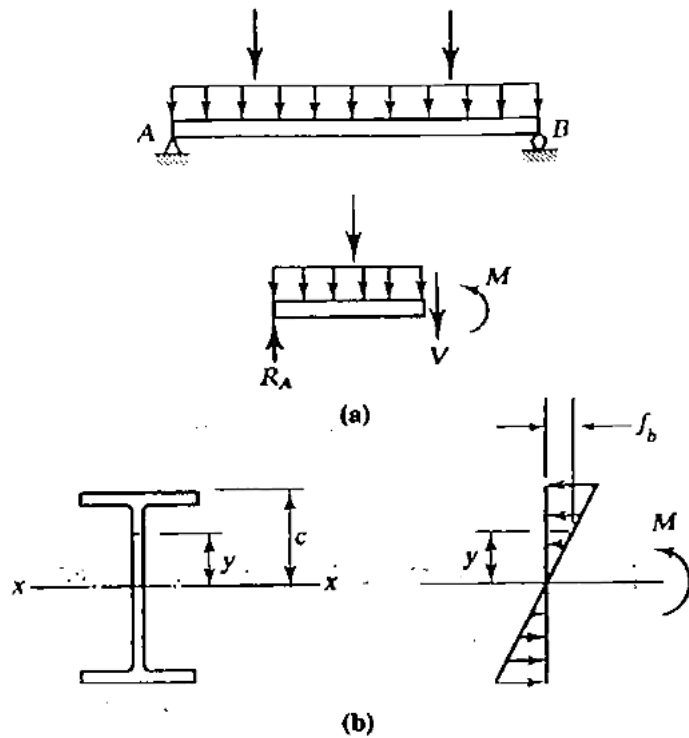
Comportamiento de la sección transversal ante cargas en viga.
